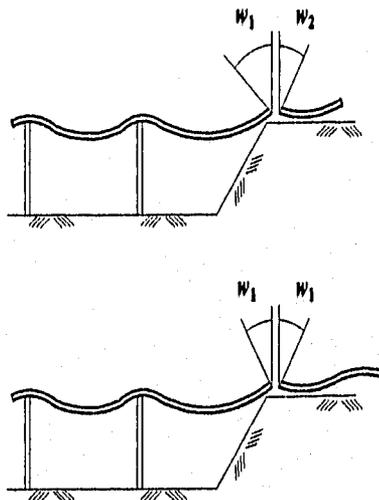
Restauración de la geometría de fabricación para una estructura de acero instalada por el método de lanzados sucesivos:
